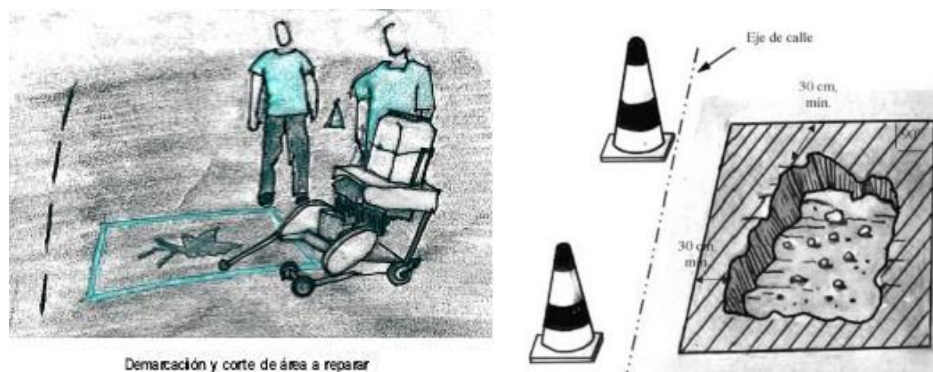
Bacheo profundo, Dosificación y corte de área a recuperar - - Fuente (Deterioros en pavimentos flexibles y rígidos)- Ricardo Javier Miranda Rebolledo Valdivia – Chile – 2010
